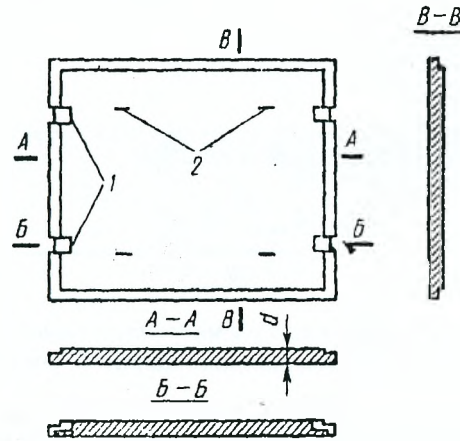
Сборная железобетонная плита, омоноличиваемая по контуру: 1 – штрабы; 2 – монтажные петли
